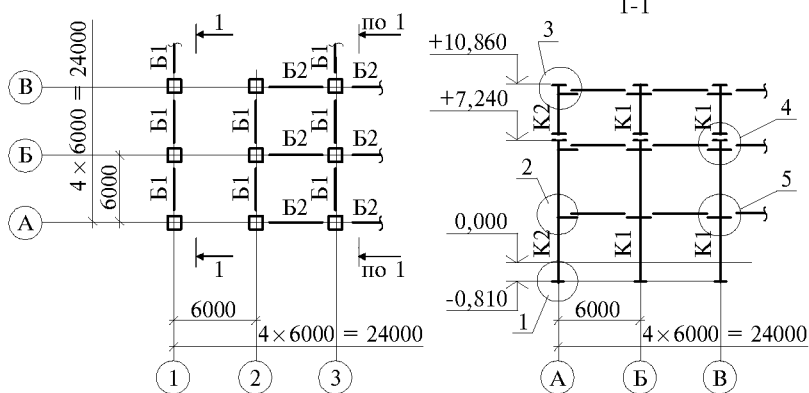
Пример оформления схемы расположения колонн и элементов перекрытий многоэтажных зданий
